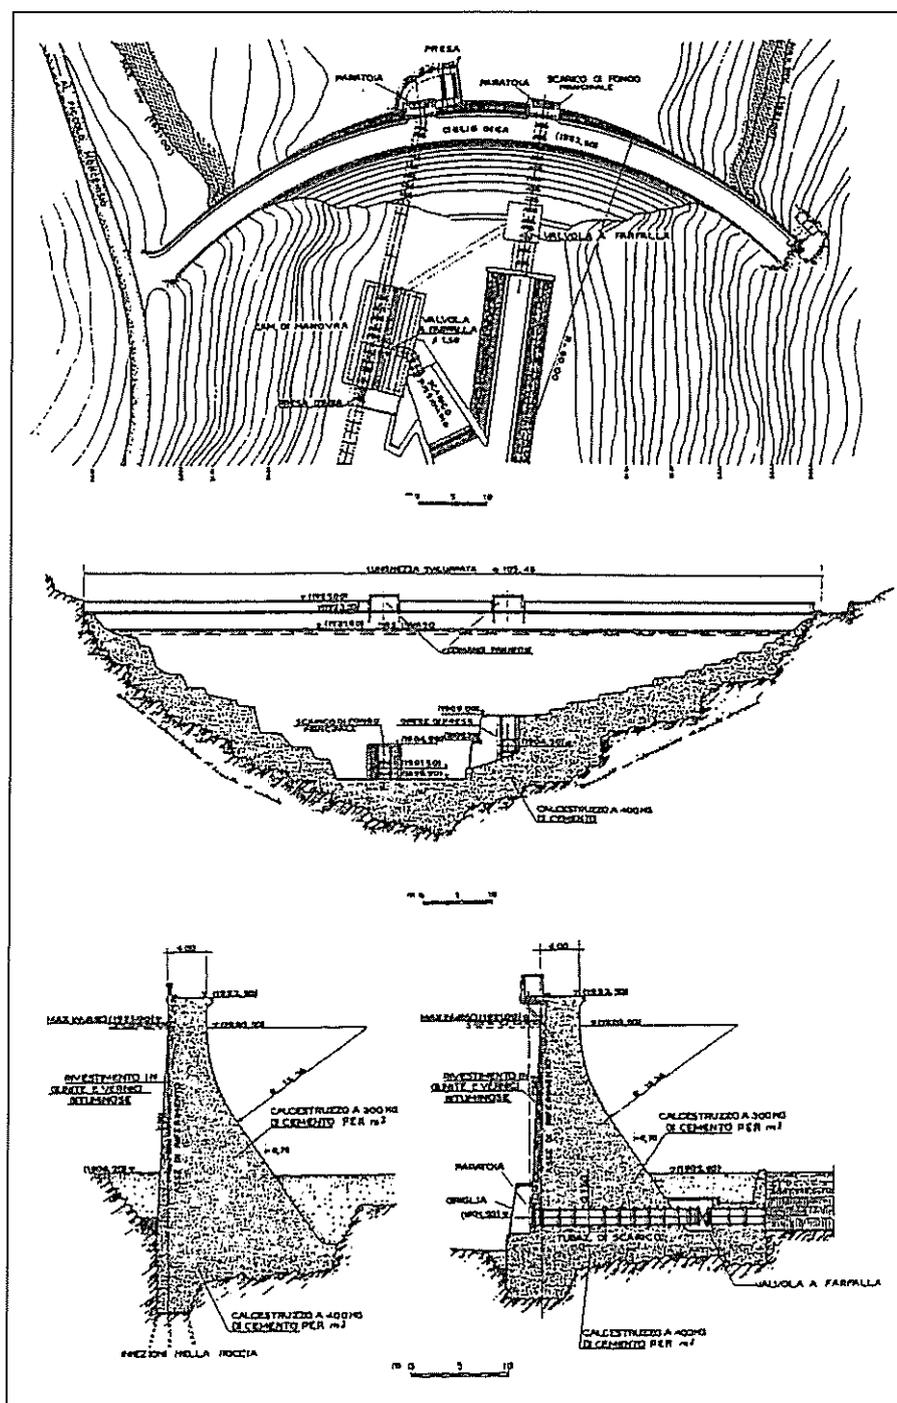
Diga Moncenisio n. 1: Planimetria - Vista da monte - Sezione tipo.
